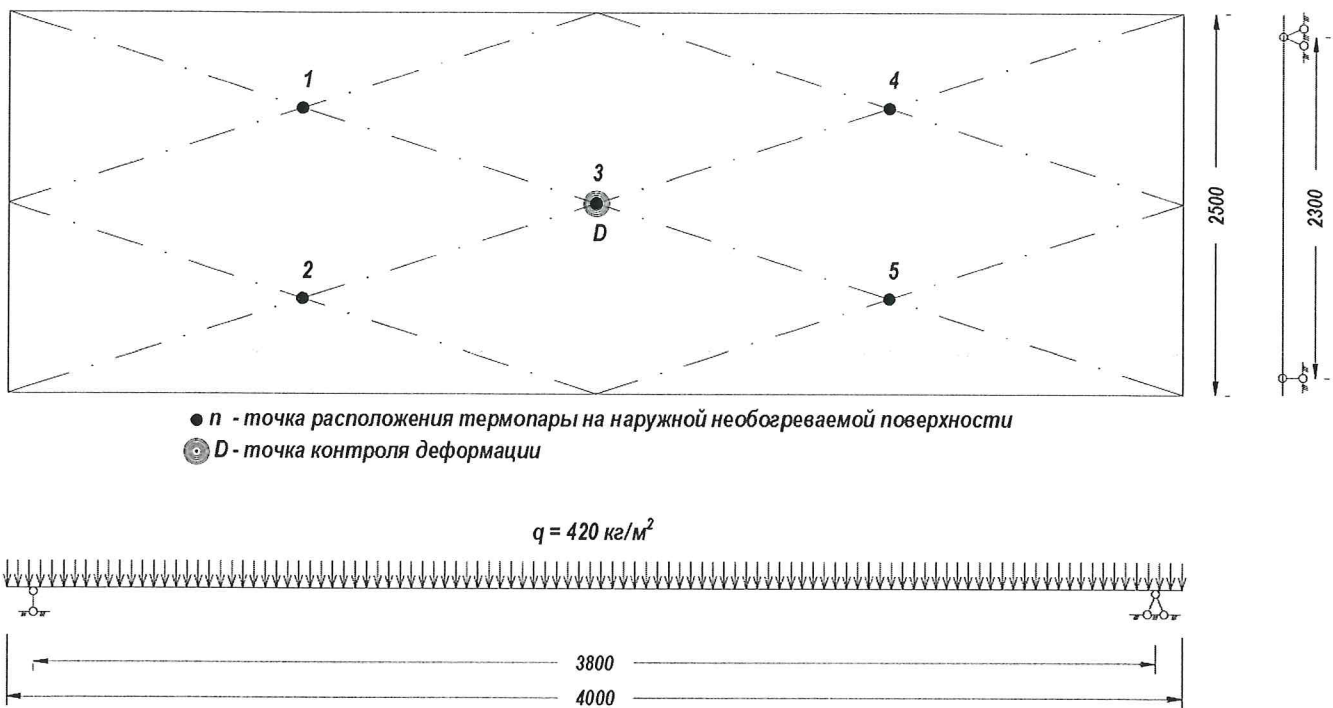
Схема расстановки термопар на необогреваемой поверхности образца и схема нагружения образца.
